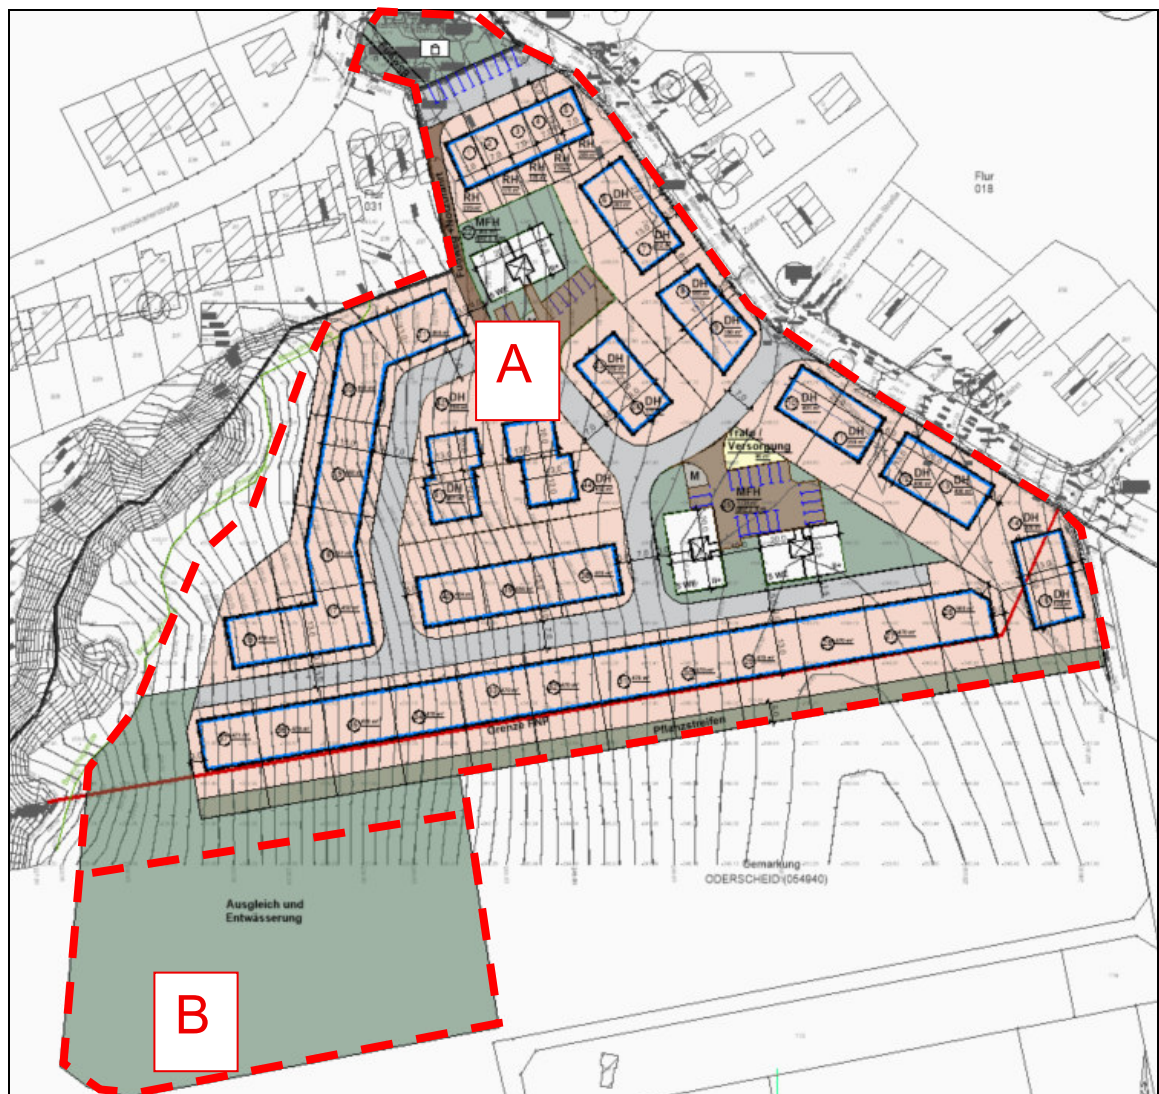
Bebauungsplan Vorentwurf (5.2.2026)
